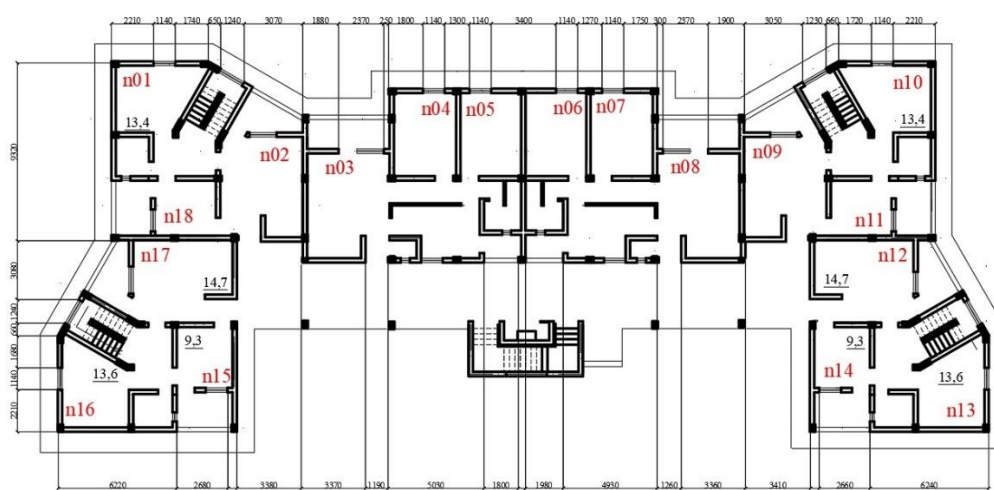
План типового этажа многоквартирного дома по ул. 60 (г. Аль-Рамади, Ирак):
